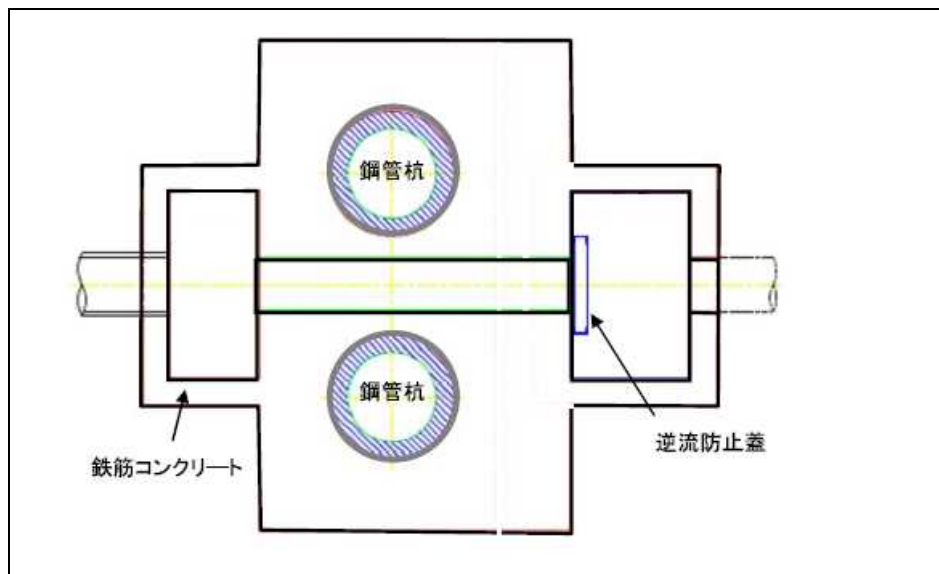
屋外排水路逆流防止設備平面図の代表例（関西電力 高浜 1, 2 号炉）
